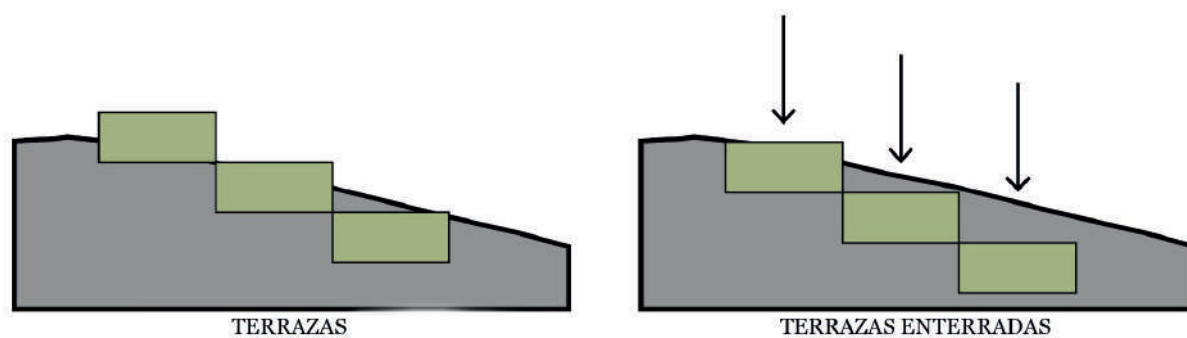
Implantación de bloques en terrazas enterradas. Elaboración propia.
